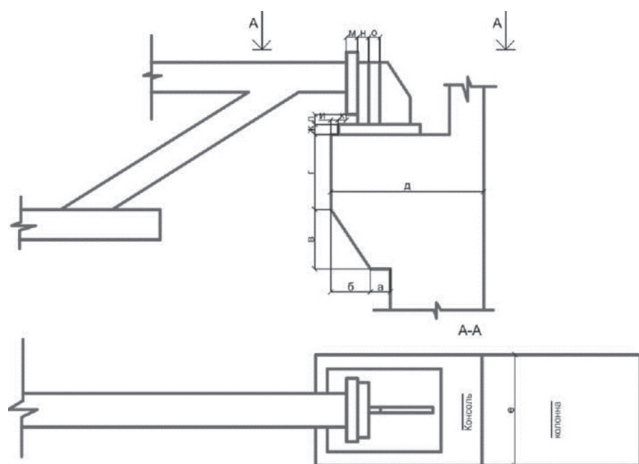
Проектная конструкция узла опирания стальных ферм на короткие консоли монолитных пилонов
